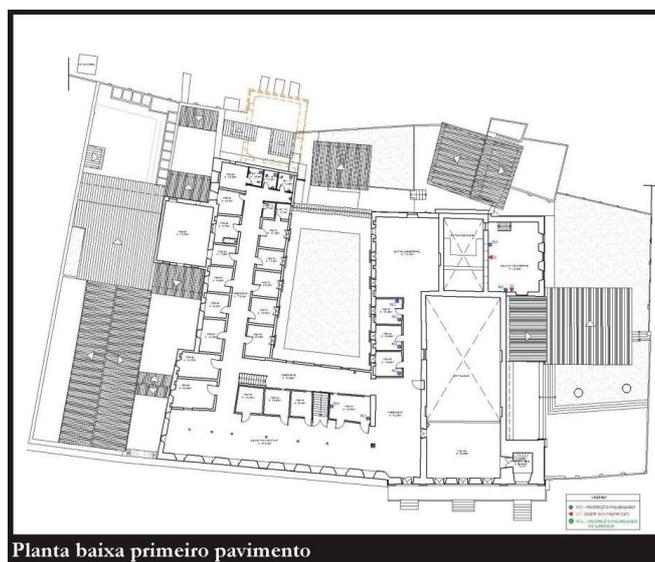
Localização dos pontos das prospecções arqueológica e arquitetônica no primeiro pavimento. Pontos de coleta de argamassa pontos vermelhos. Fonte: Elaborado pela autora
